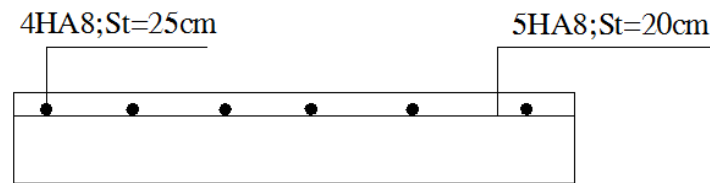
Schéma de ferrailage de la dalle sur deux appuis
